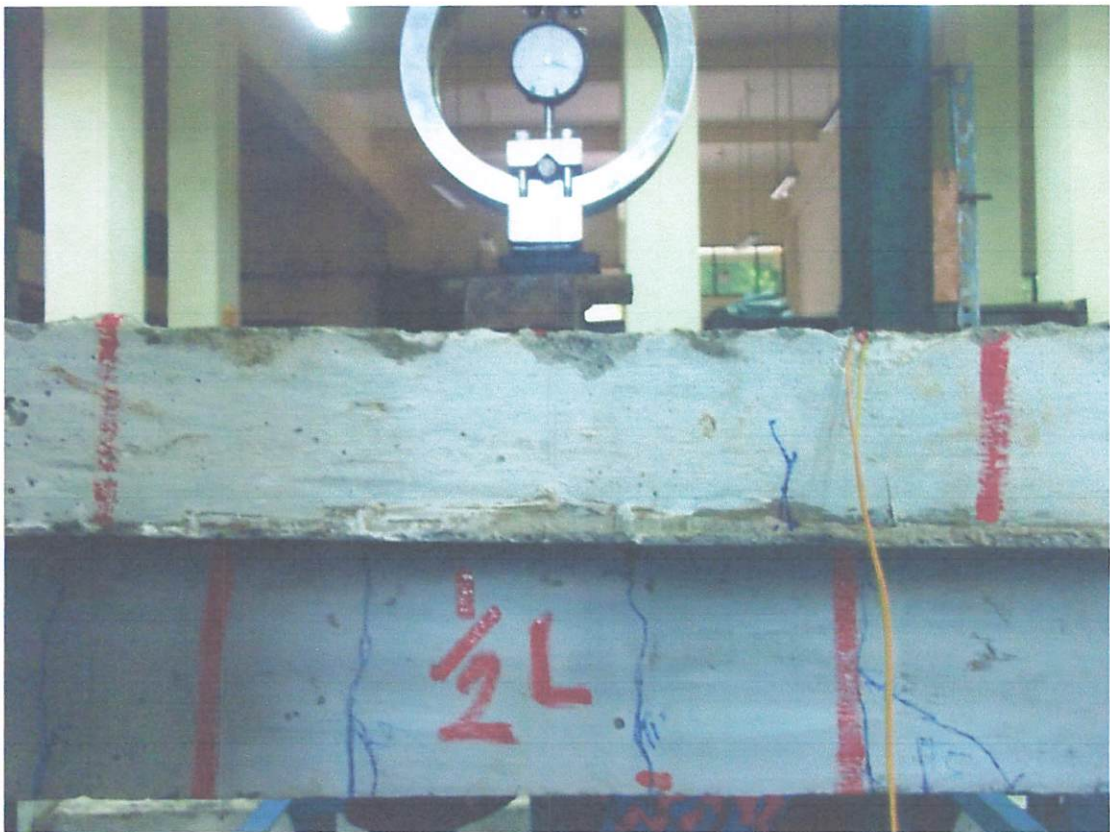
Pola retak balok T dengan jarak sambungan beton dan tulangan
